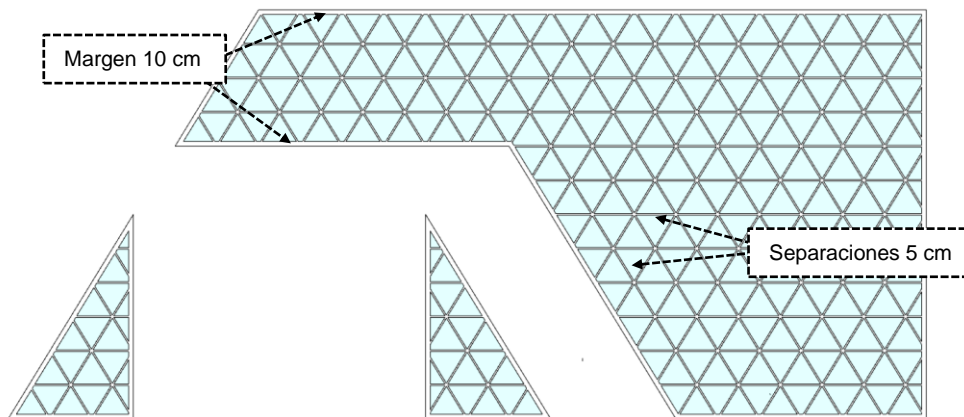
Estructura Paneles de Vidrio, Malla 3, Muro Acristalado, Fase 2
